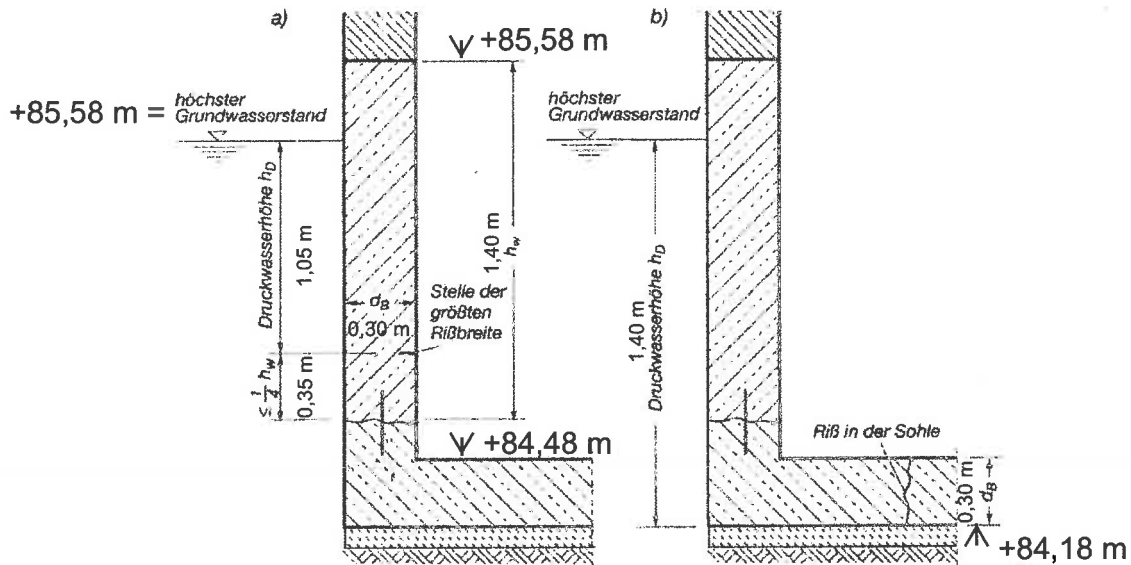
Bestimmung der Druckwasserhöhe h_D zum Festlegen der unbedenklichen Rissbreite w_{cal} für die Selbstheilung von Rissen im Beton
